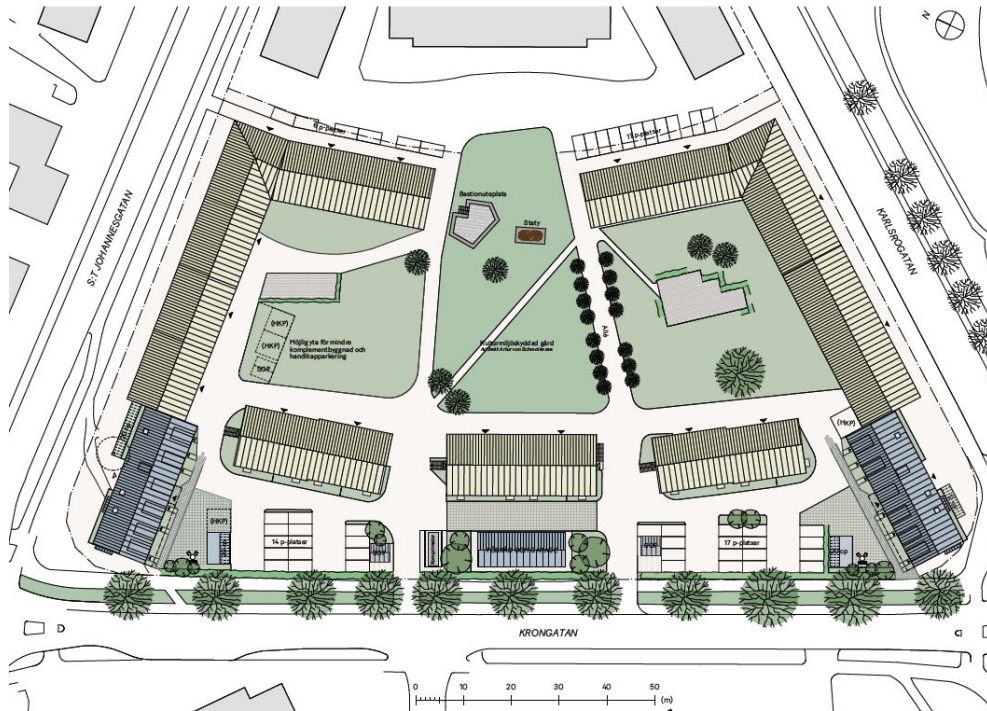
Illustrationsplan över planområdet. (Krook och Tjäder)
